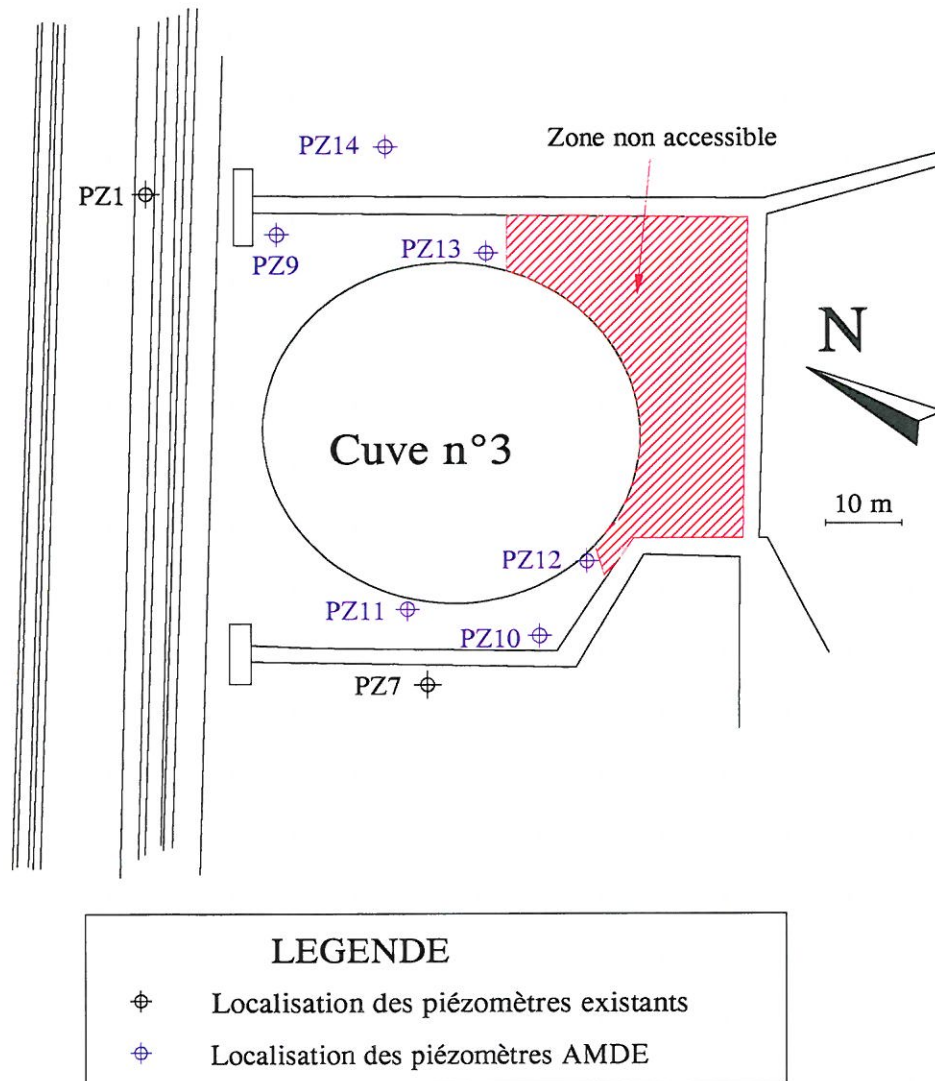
Plan d'implantation des forages A.M.D.E.
